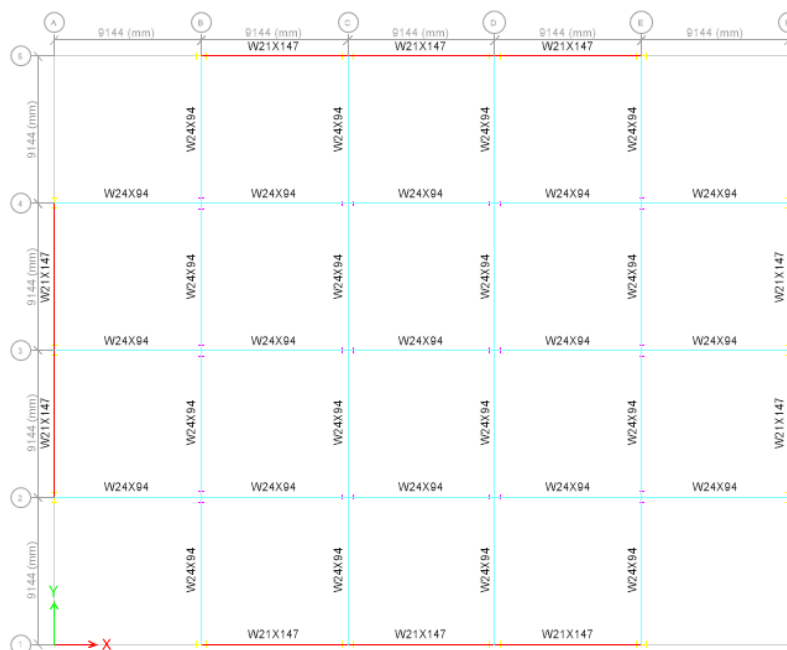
Vista en planta de la distribución de los pórticos para los dos modelos.
